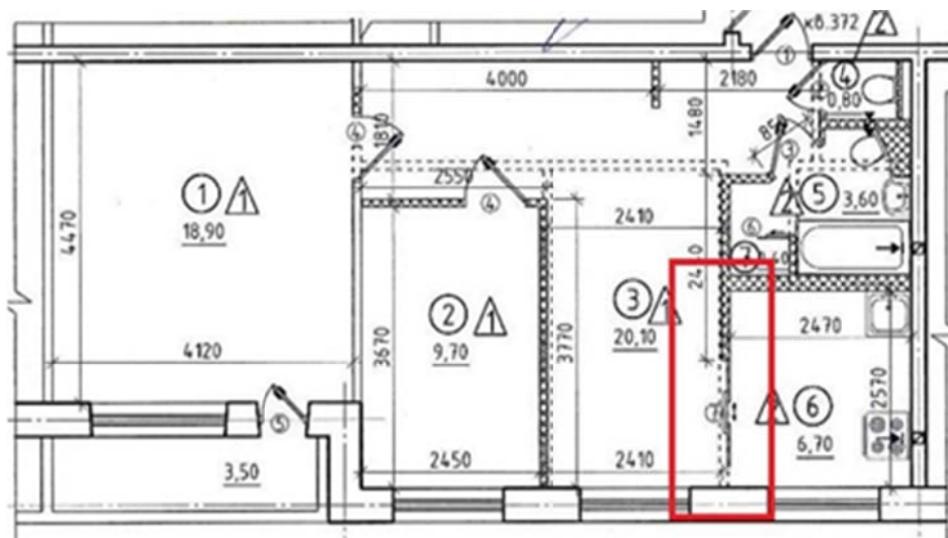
Пример устройства раздвижных дверей на плане помещения между кухней и холлом
